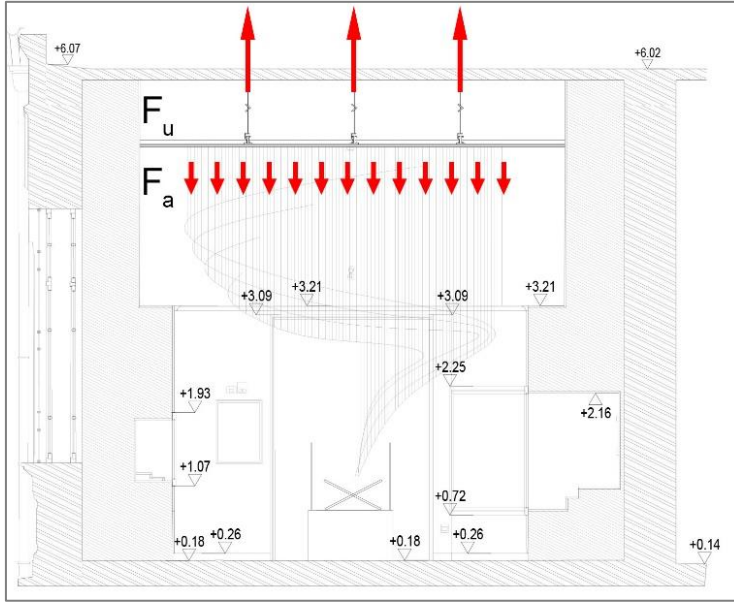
El Yazmaları salonunun tavan planı (Plan çizimi Rölöve ve Anıtlar Müdürlüğünden alınarak yazar tarafından düzenlenmiştir)
